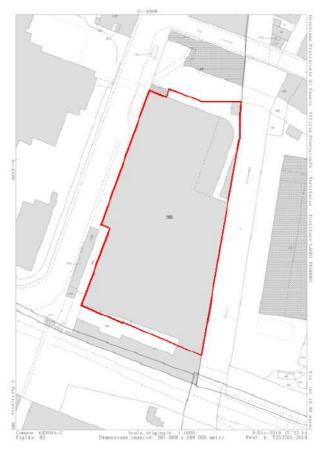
Stralcio della Planimetria catastale con evidenziati i confini dell'edificio oggetto di intervento
